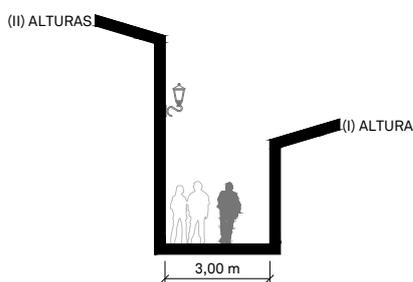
y 137. Calle Vinalesa. Elaboración propia.
